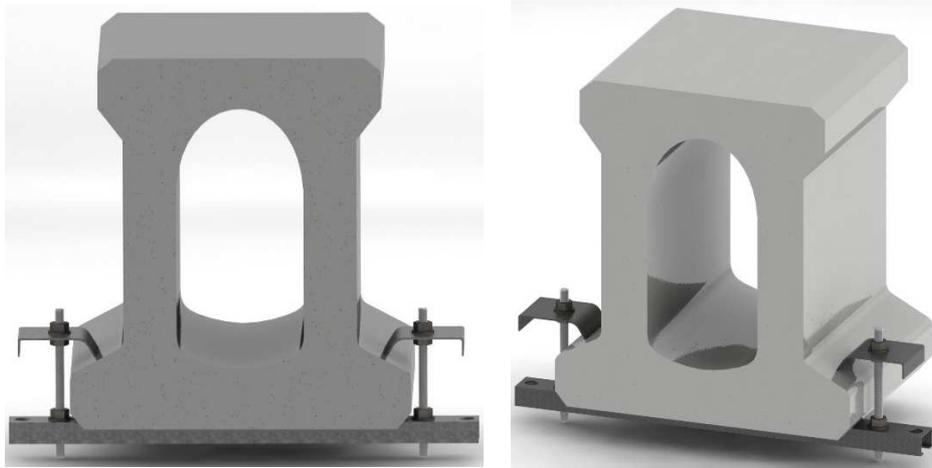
Sistema de sujeción sobre perfil de hormigón pretensado.
